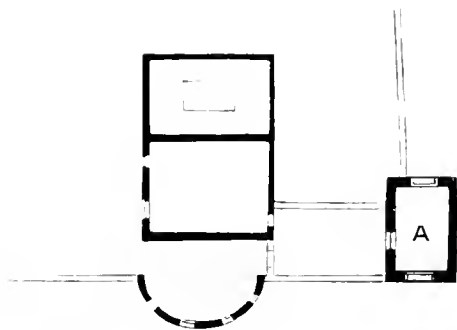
(Kronburg. Grundriß der Thorbefestigung.)
